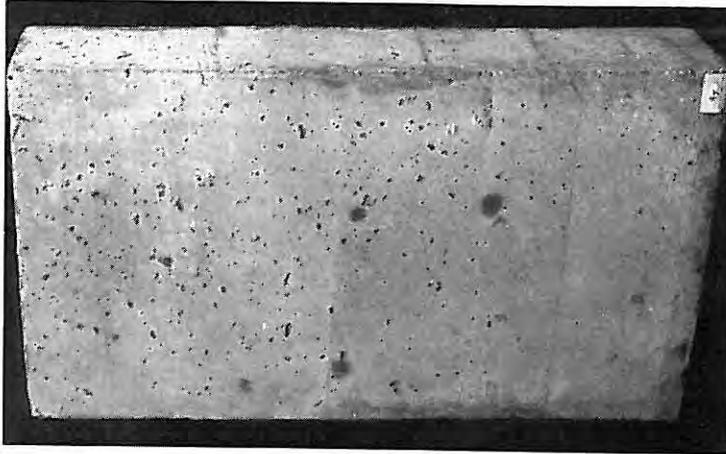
Beschaffenheit einer Betonplatte 70 · 40 · 15 cm aus Beton mit 300 kg Zement je m³ vor dem Auslagern (Platte e1)
